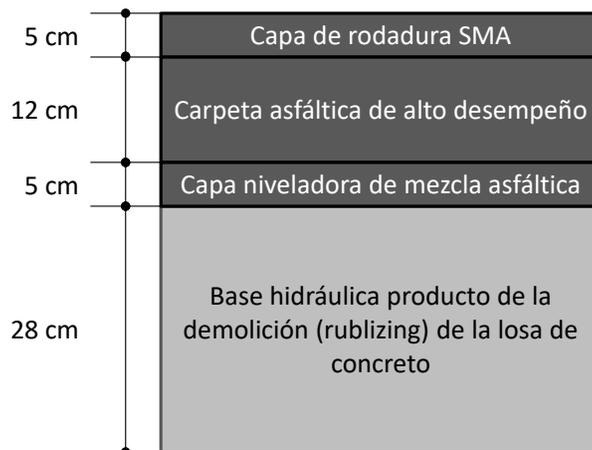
Diseño para la alternativa de pavimento asfáltico.
